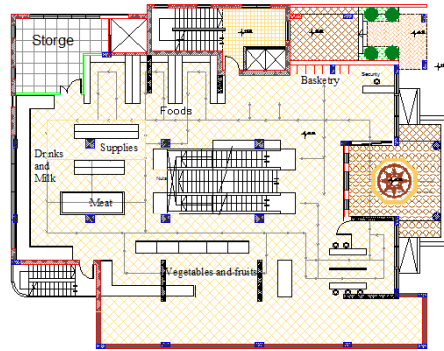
المسقط الأفقي للطابق الأول (التسوية -1-).
